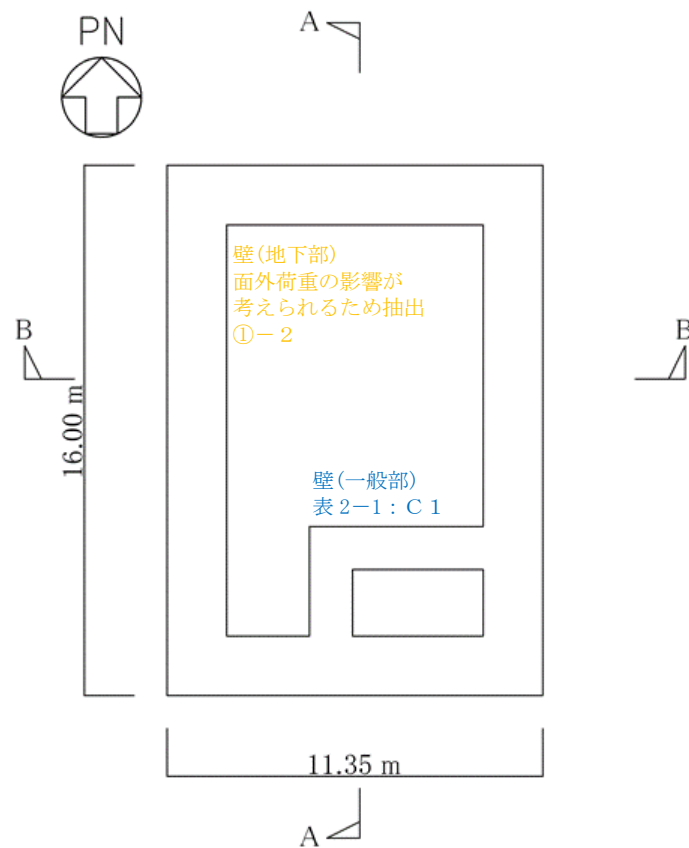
格納容器圧力逃がし装置格納槽の概略平面図 (EL. -12.8m)
